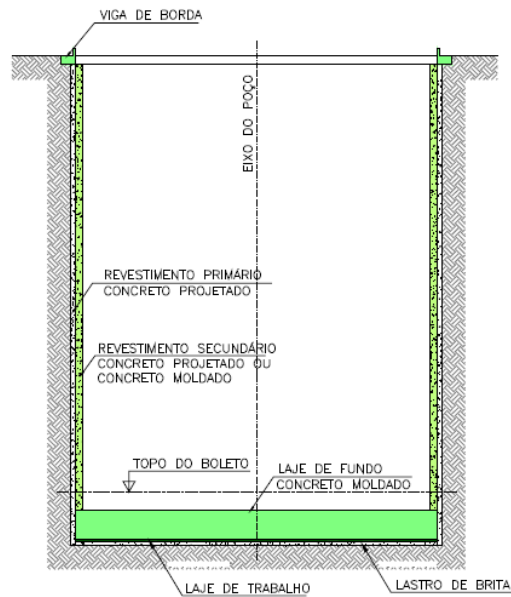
Elementos construtivos de um poço (Campanhã & França 2008)
